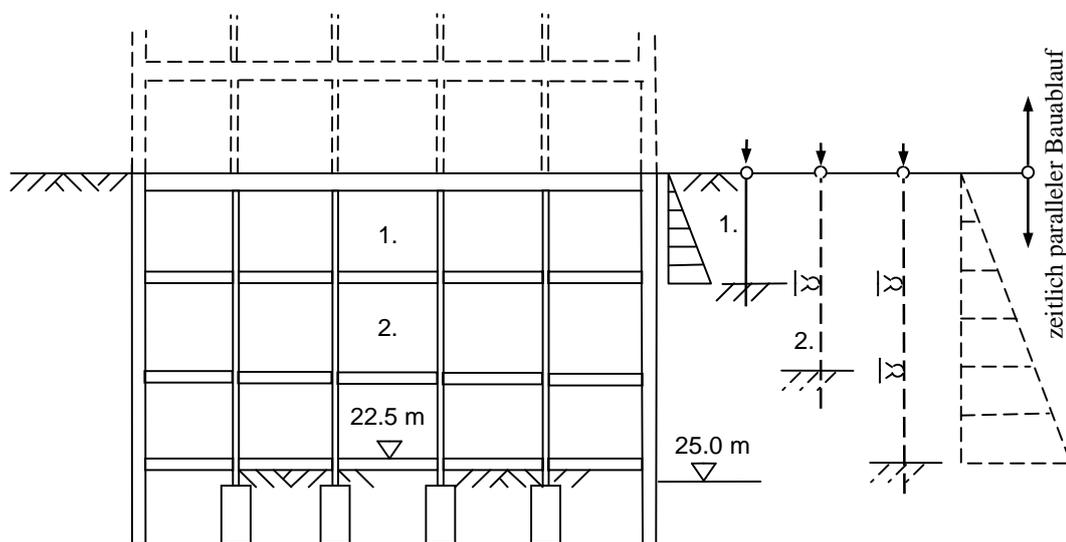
Deckelbauweise in Stockwerksbauweise mit etappenweisem Aushub und Deckelbau
